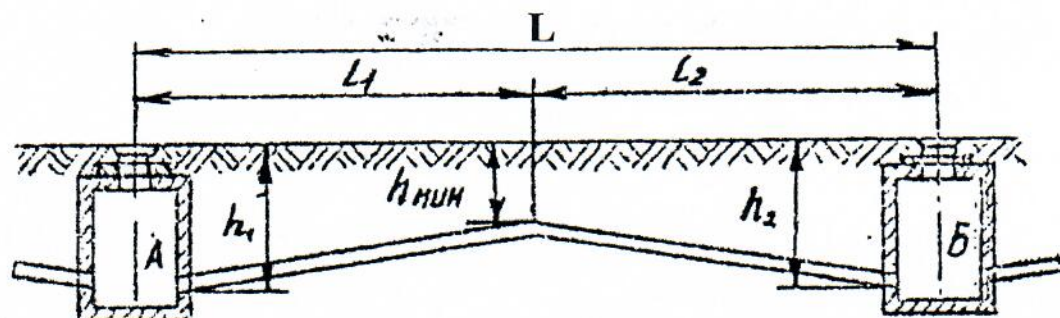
Схема прокладки трубопровода с уклонами в обе стороны на местности, не имеющей естественного уклона
